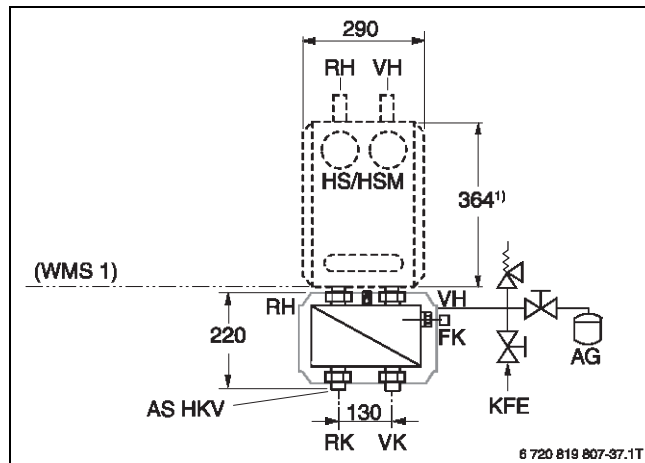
Abmessungen Anschluss-Set Wärmetauscher Systemtrennung mit Heizkreisanschluss-Set (Maße in mm)
